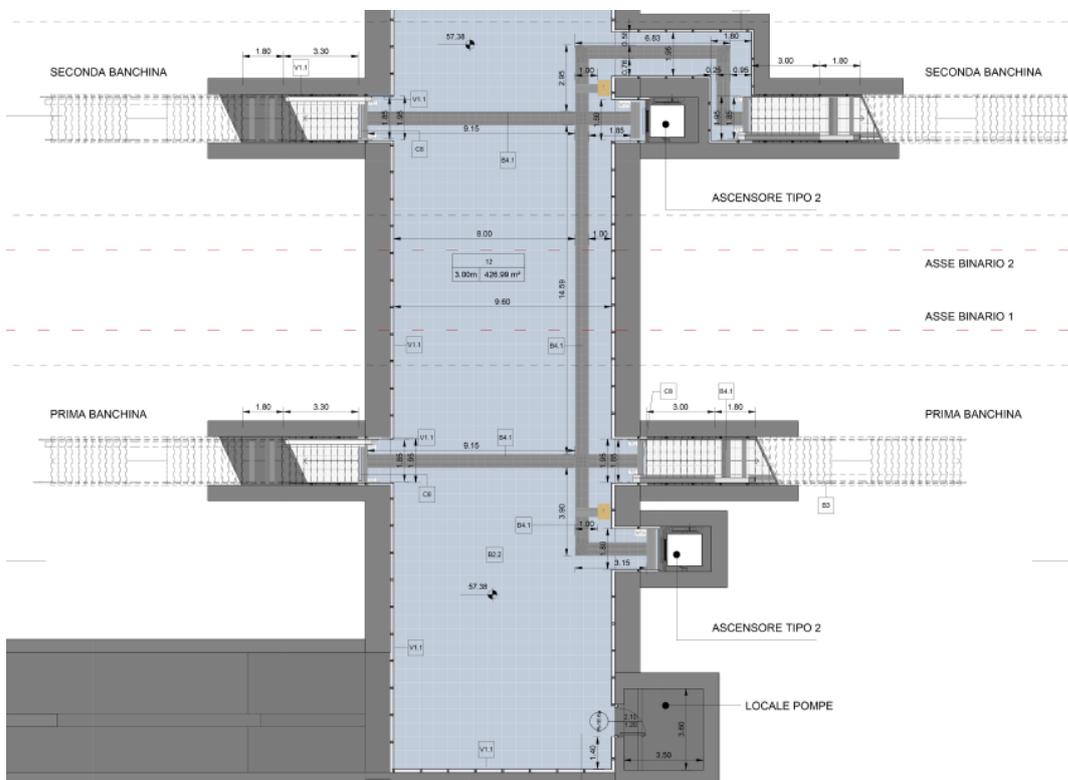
Pianta sottopasso e rampe e nuclei ascensore
